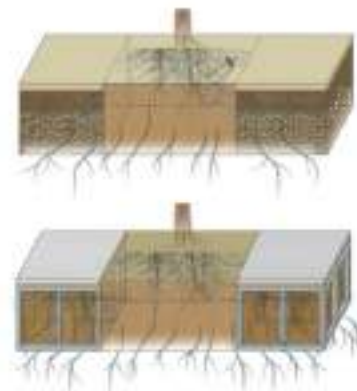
Propuestas de salud estructural para alcantarías. Arriba: salud estructural con grava. Abajo: salud estructural con césped. Ambas permiten un correcto desarrollo radicular. Fuente: Mardell y Sponso (2022).
